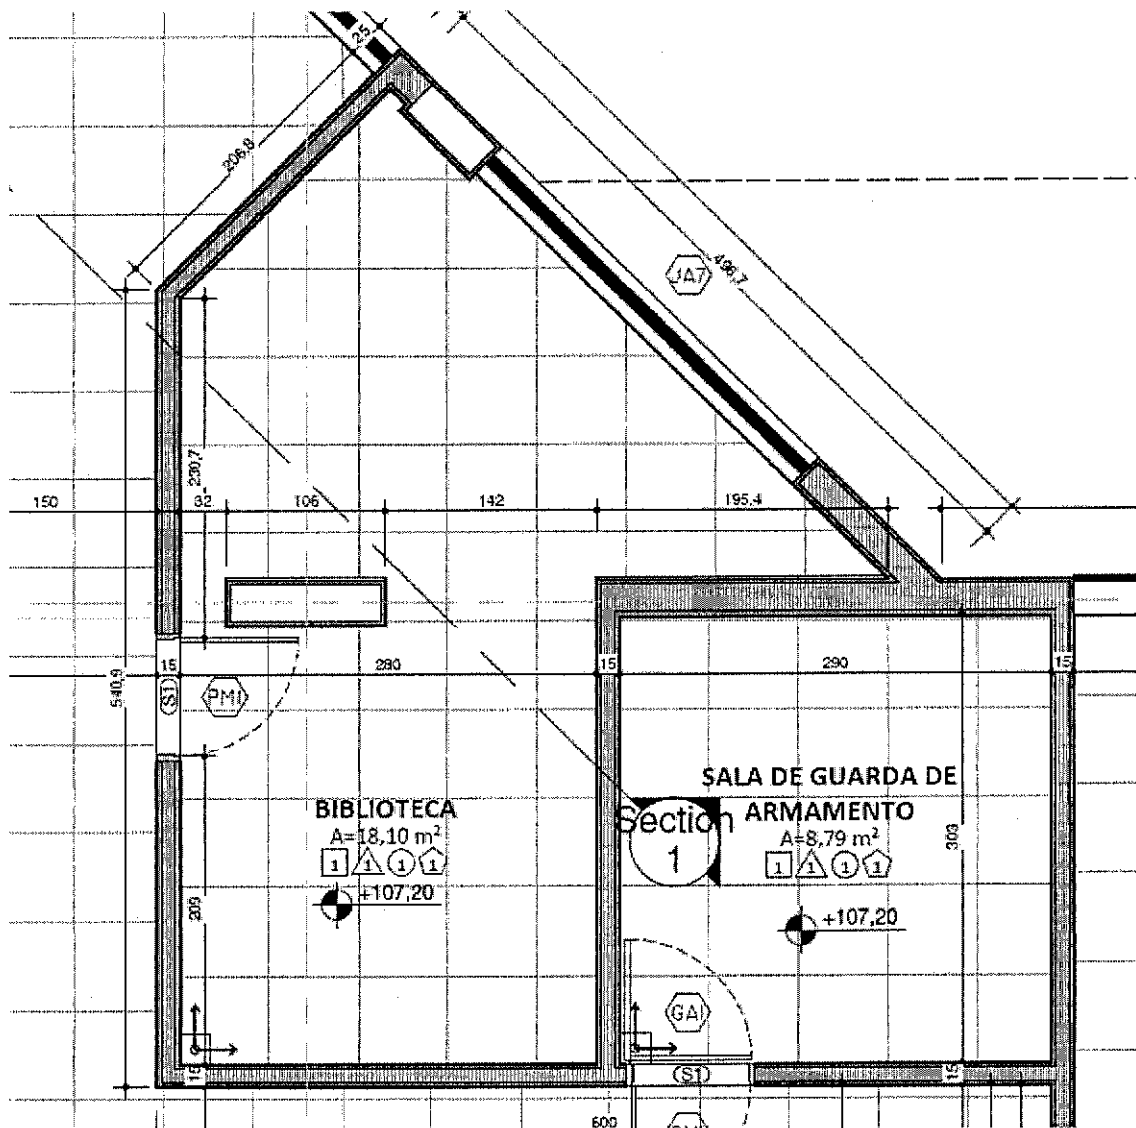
planta do 1º pavimento da obra DRF Bauru (CAT 2620180009585), área de biblioteca com 18,10m². Obra de Construção.
